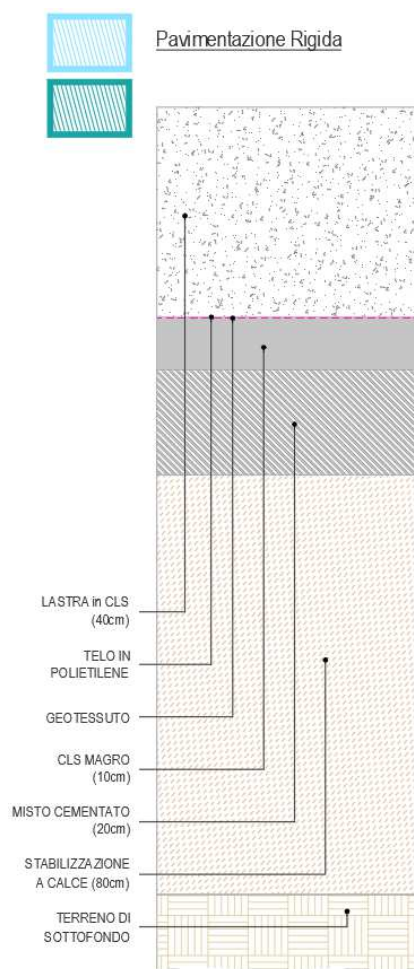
Stratigrafia pavimentazione delle aree di stazionamento aeromobili
